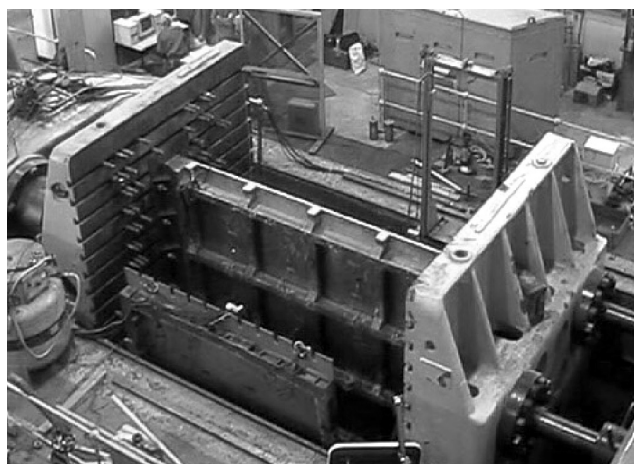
Испытания натурного перекрытия размерами 5×3 м с тавровыми балками и трехслойным настилом из стеклопластика на сжатие вдоль балок
